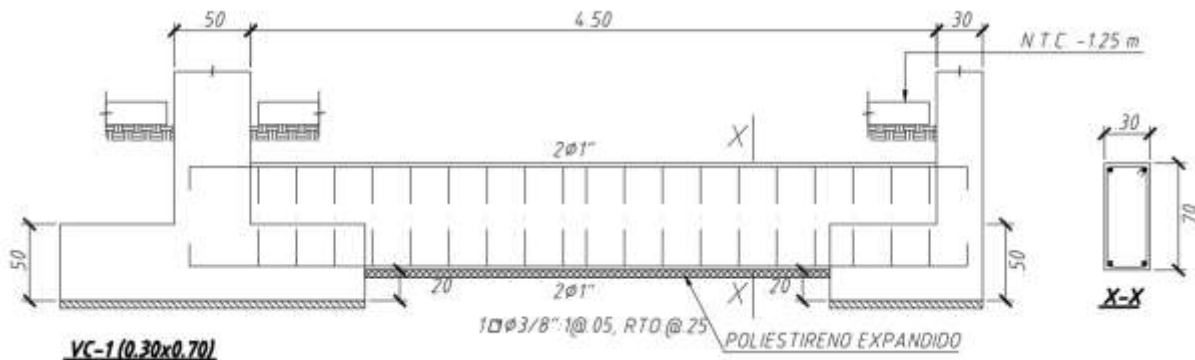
Disposición de acero de la viga de cimentación VC-1
